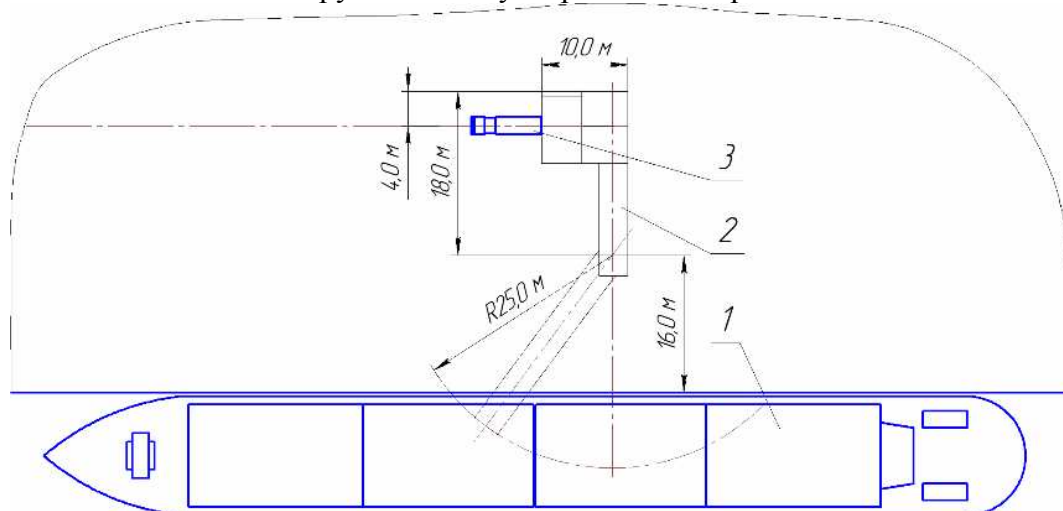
План перегрузочной площадки МЛ7 на МП5: 1 – сухогрузное судно; 2 – погрузочный комплекс СКПЛ-10/1; 3 – АТС
